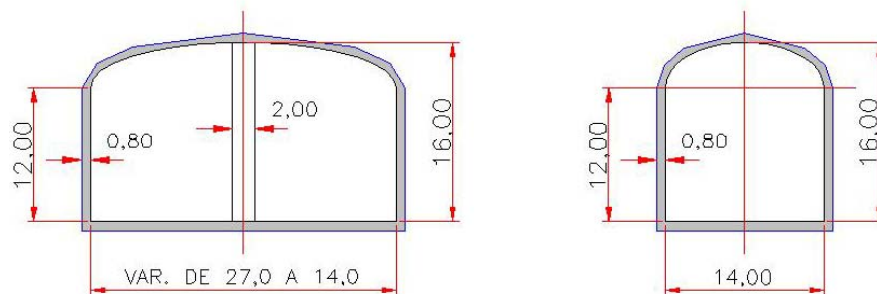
Sección transversal de los túneles de la obra de excedencias.
